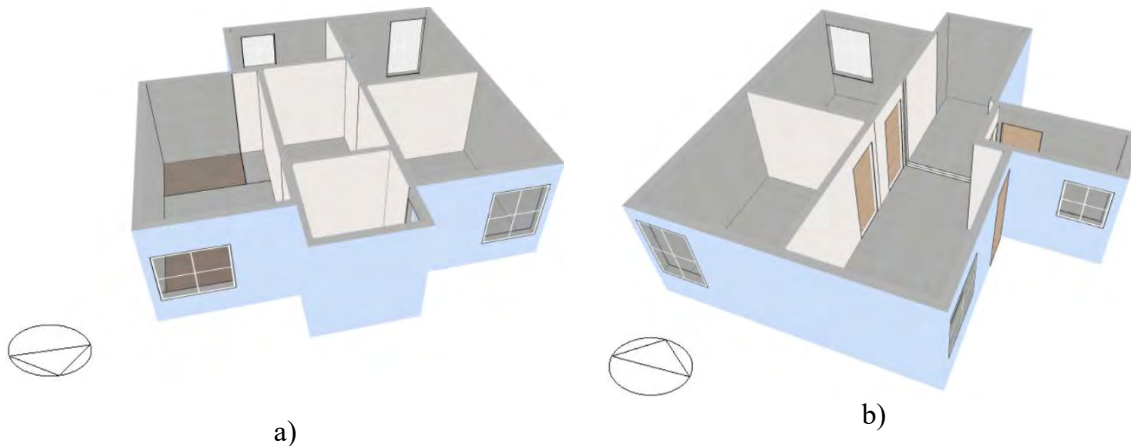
Vista de la vivienda en a) planta alta y b) planta baja.
